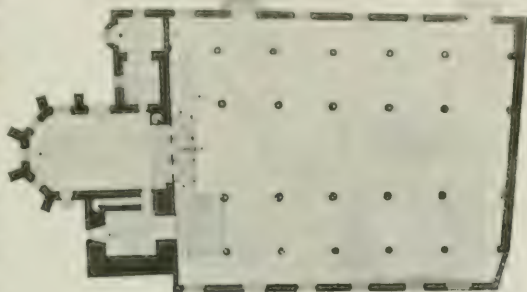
Schaffhausen, St. Johann: Grundriss
